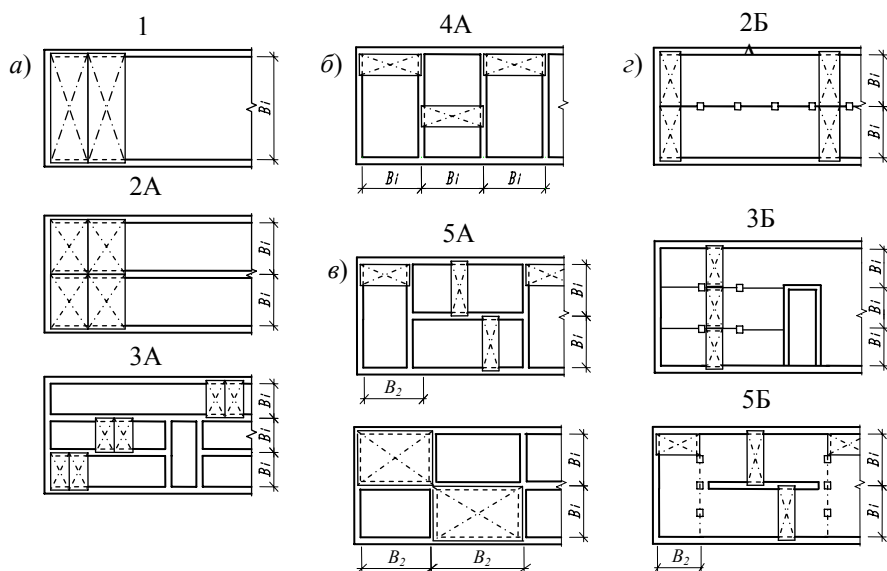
Конструктивно-планировочные схемы кирпичных зданий с продольными (а), поперечными (б) и перекрестными (в) несущими стенами и с неполным каркасом (з):
